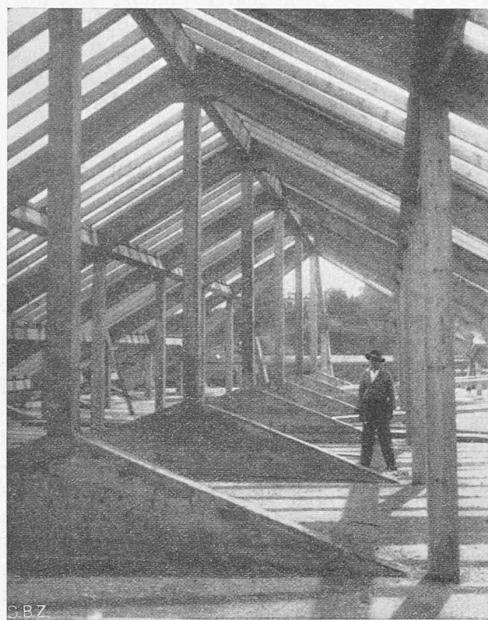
Blick in den Eisenbeton-Dachstuhl mit hölzerner Sparrenlage. — Ing. R. Maillart, Zürich-Genf.
